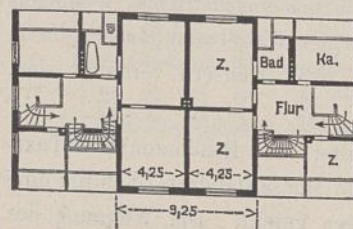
Verwalterwohnhaus. Dachgeschoß.
